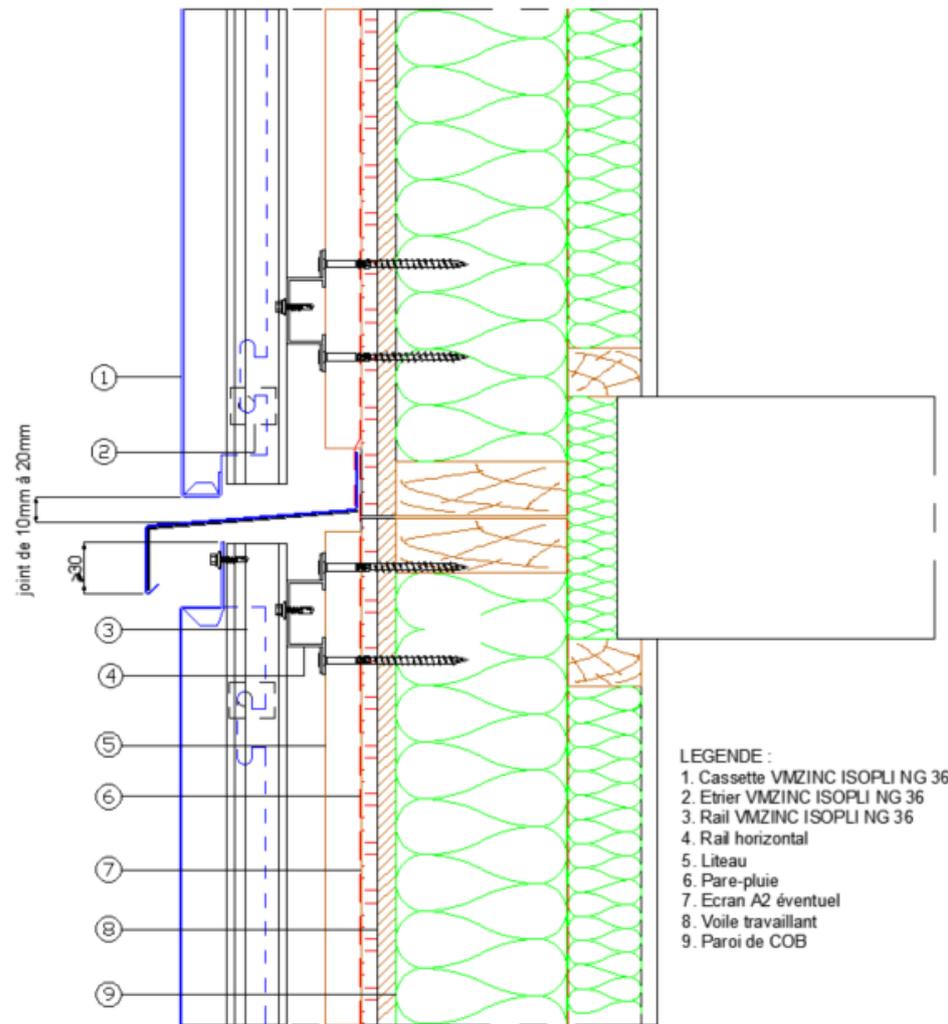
Fractionnement horizontal de la lame d'air et recouvrement du pare-pluie tous les 3m sur COB et CLT
